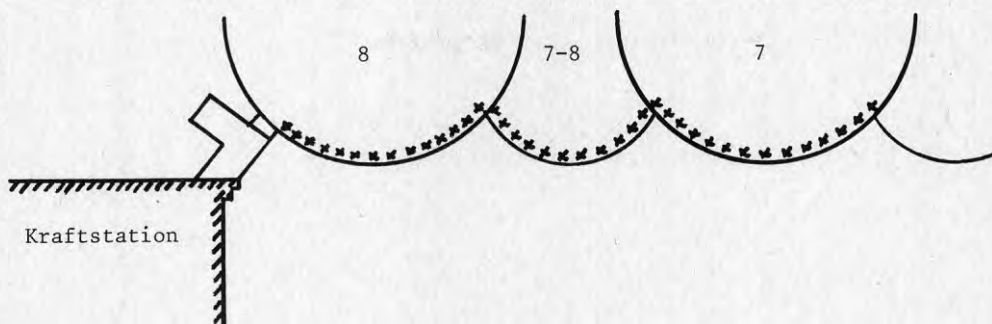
Visar med kryssen, injekterings-skärmens placering under fångdammen.
